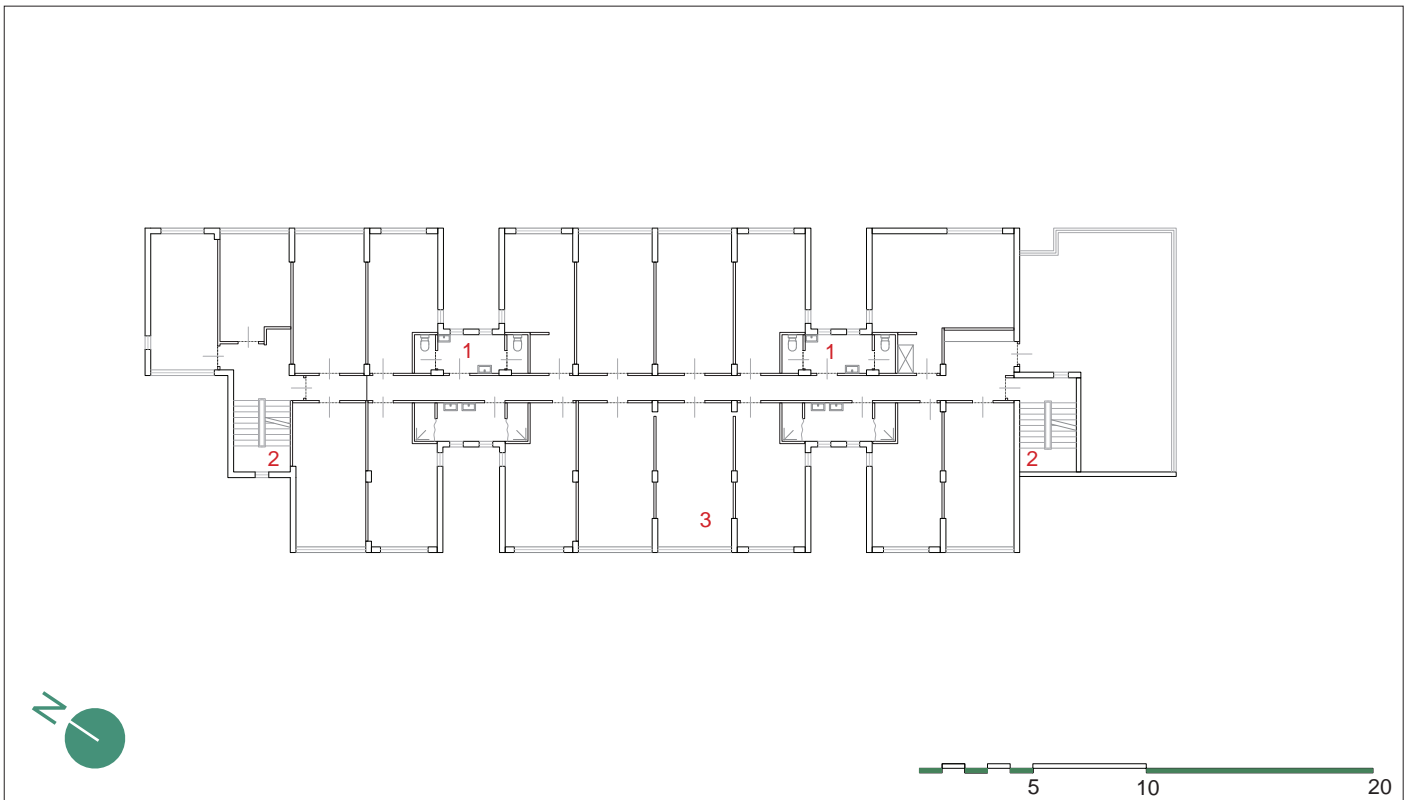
Grundrissplan - Regelgeschoss - I-House 3
